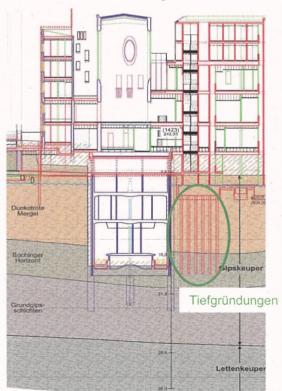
Lageplan Tiefgründungen (55 Pfähle DN 75) im Bereich S-Bahn-Tunnel
